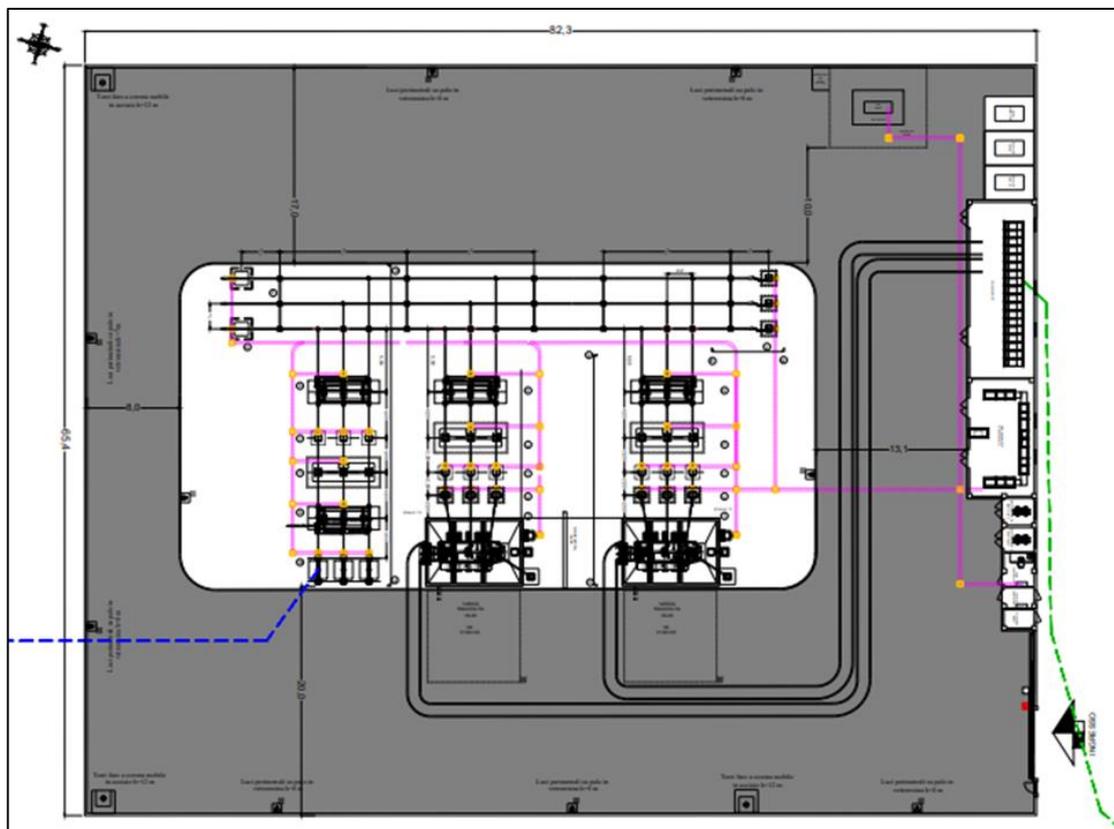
Planimetria elettromeccanica Sottostazione Utente 132/15 kV
